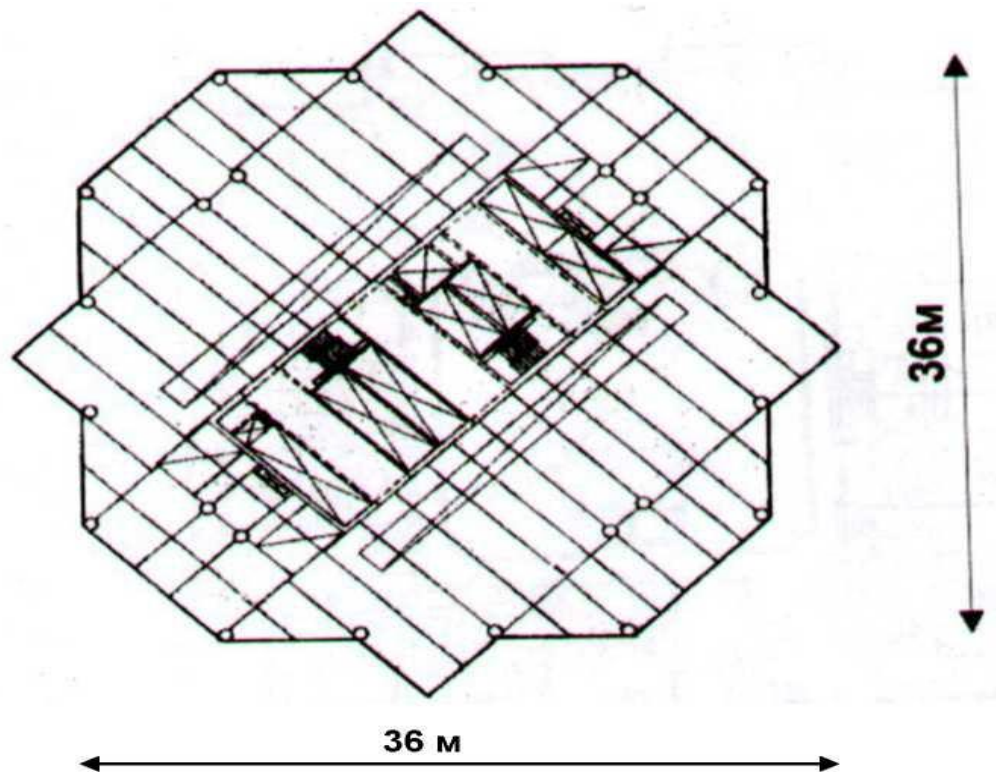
План житлової будівлі з трубобетонними колонами в м.
